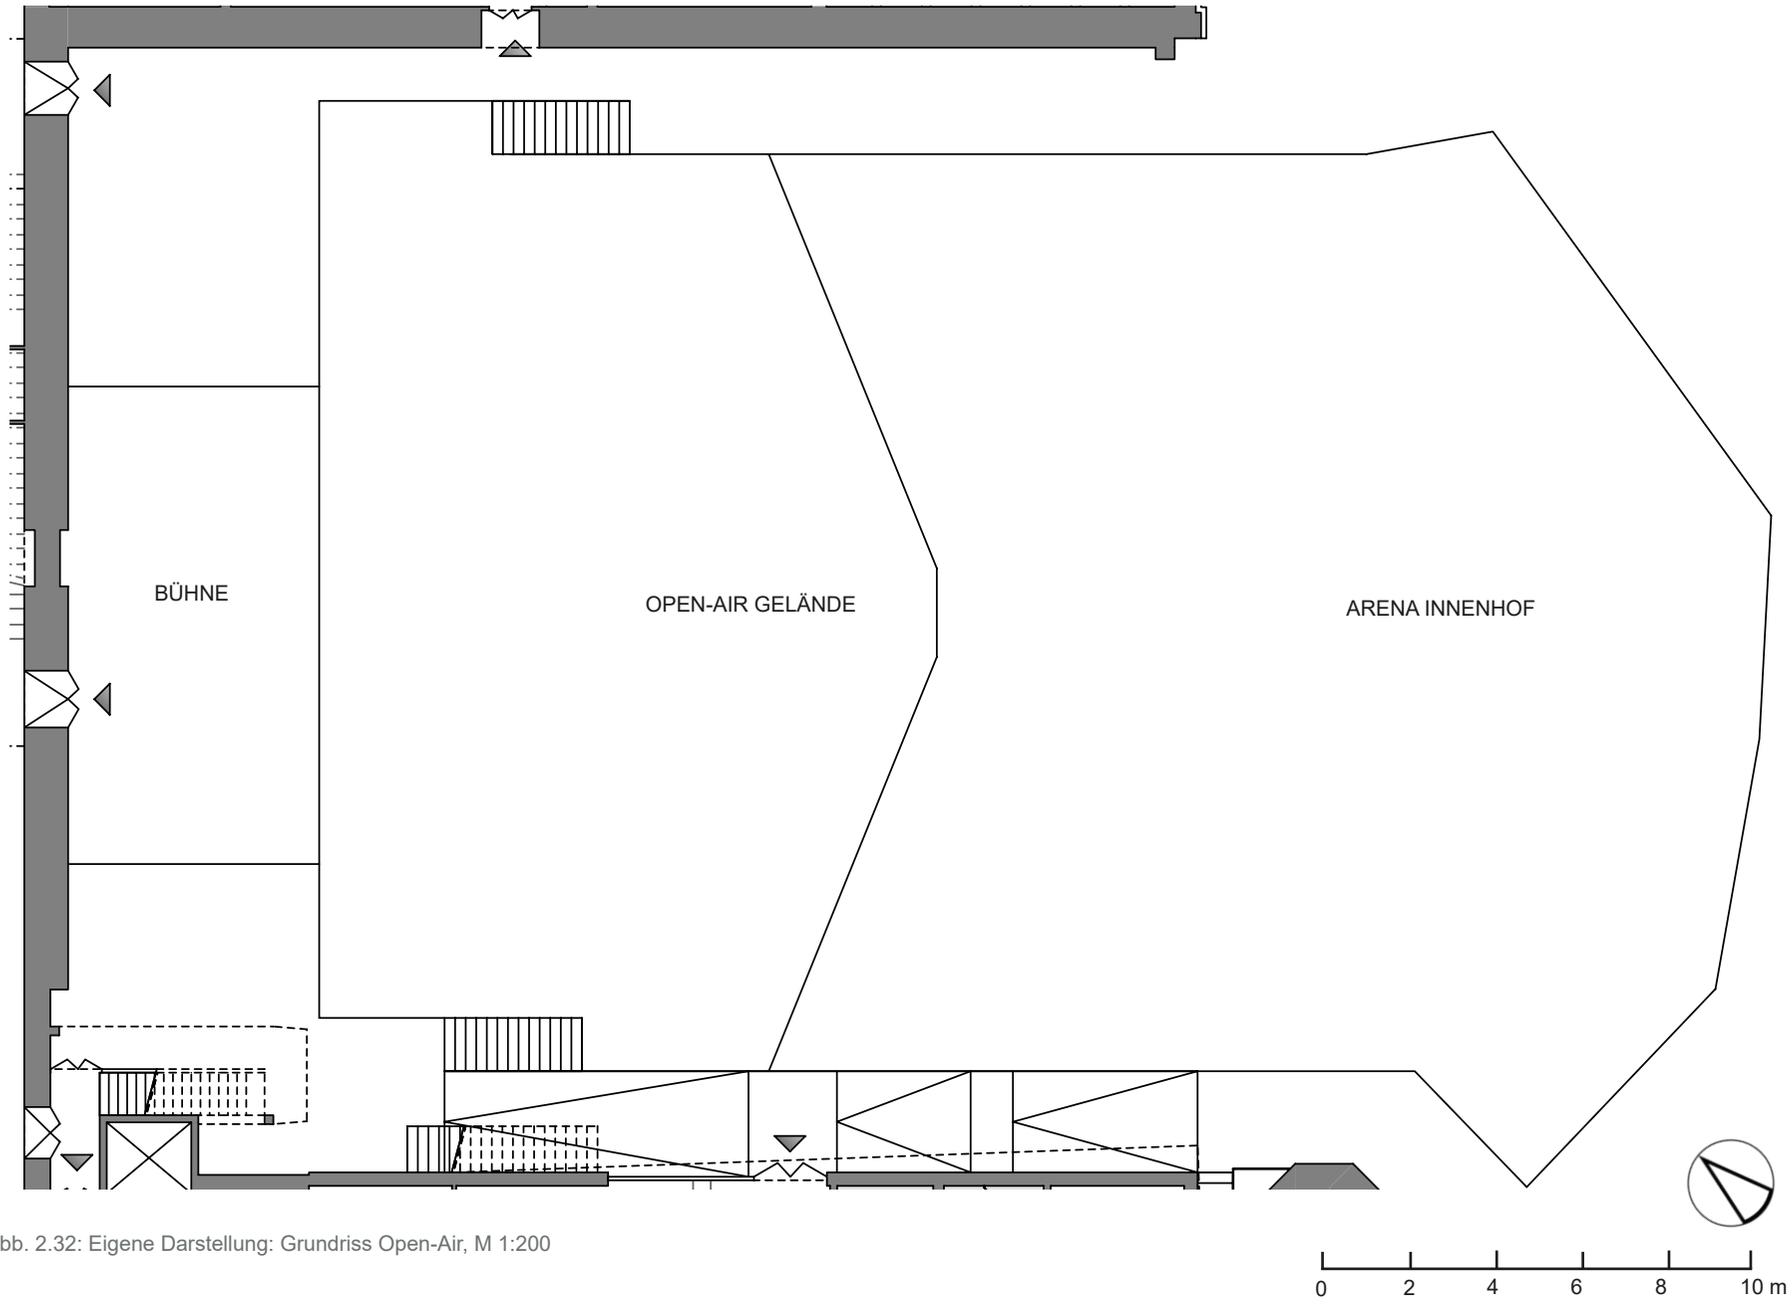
Eigene Darstellung: Grundriss Open-Air, M 1:200
